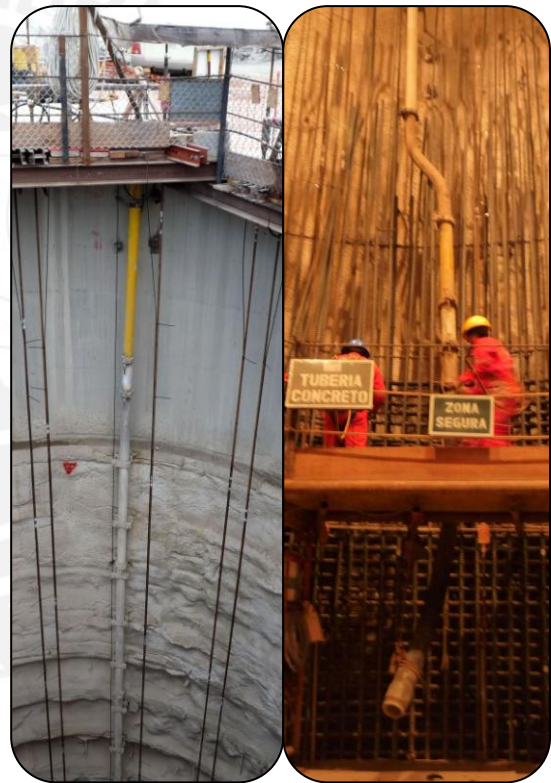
Tubería de acero usada con bomba estacionaria para suministro de concreto.
